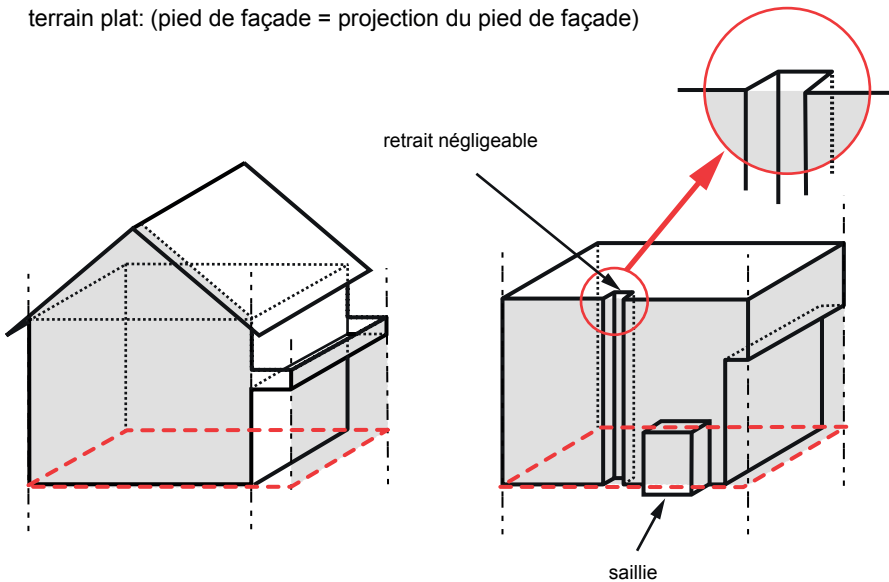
Plan de façade et projection du pied de façade (sur terrain plat)
